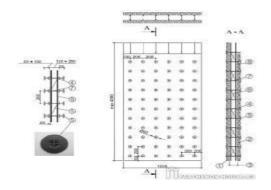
Несъемная опалубка - вид спереди, вид сверху и поперечное сечение: 1. Наружная пенополистирольная плита; 2. Внутренняя пенополистирольная плита; 3. Толщина стены из монолитного бетона; 4. Полипропиленовый дистанцер; 5. Полипропиленовая гайка; 6. Диагональный стержень (диаметр 3 мм); 7. Поперечный стержень (диаметр 5 мм) с резьбой; 8. Вертикальная продольная арматура (диаметр 08, 10 или 12 мм).
